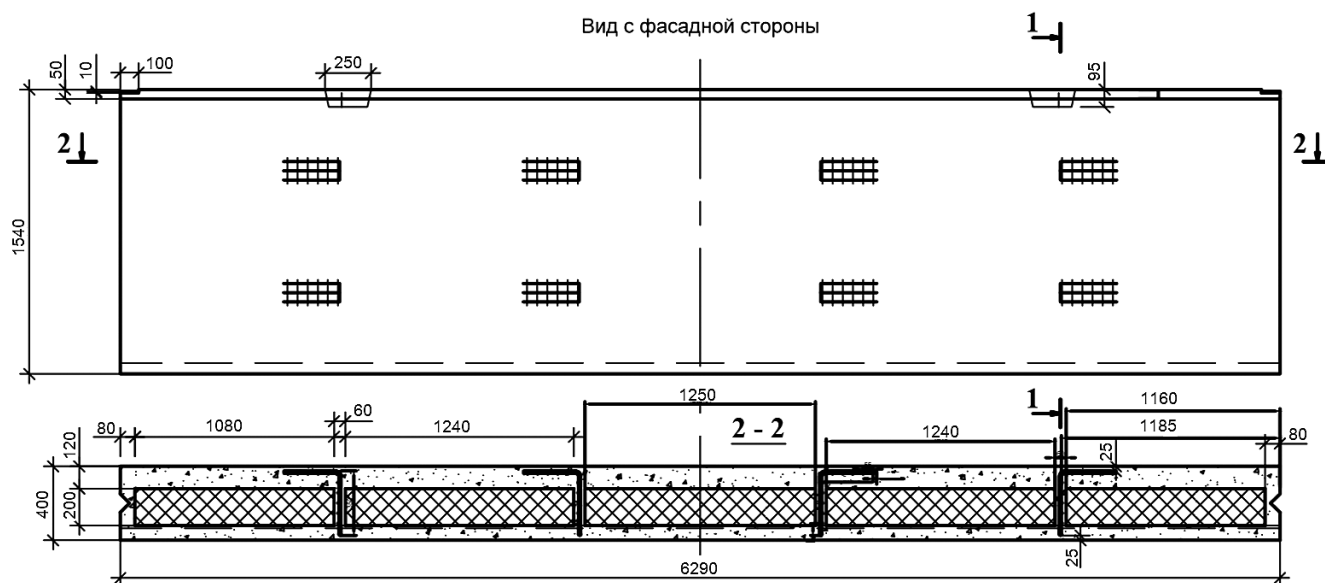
Техническое решение наружной стеновой панели с железобетонными шпонками
